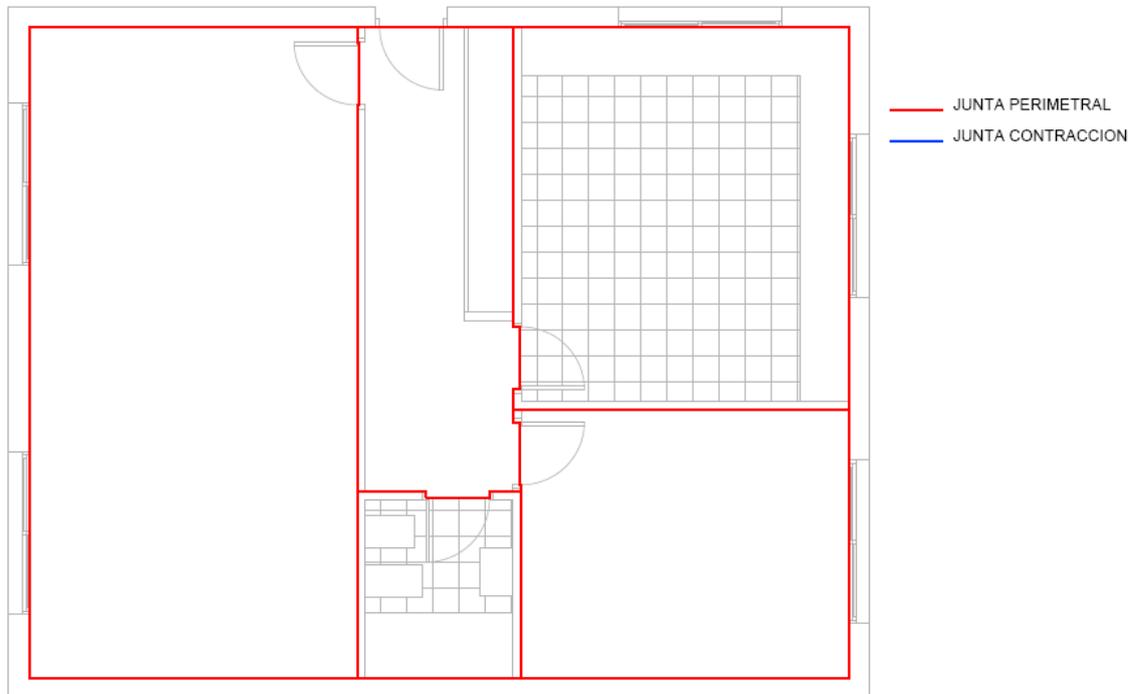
Ejemplo de juntas en pavimento después de la tabiquería
